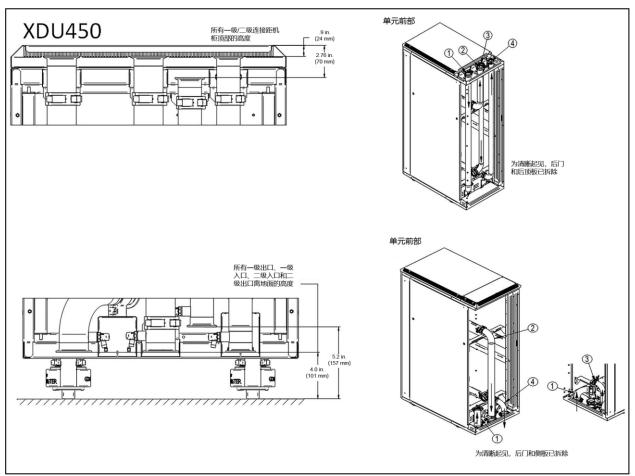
显示一级设施和二级管道连接位置的背面剖面图
